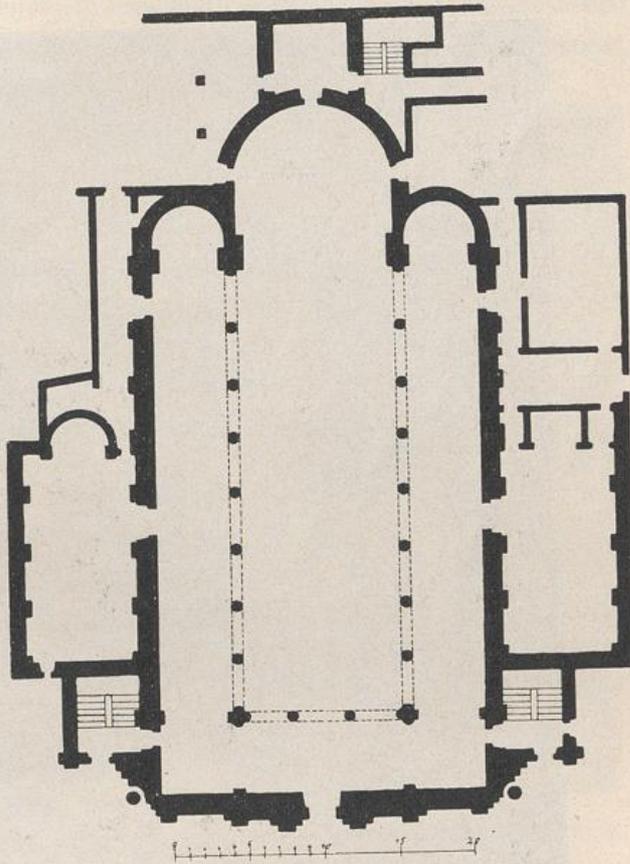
Antwerpen. Frühere Jesuitenkirche. Grundriß. Originalplan.
